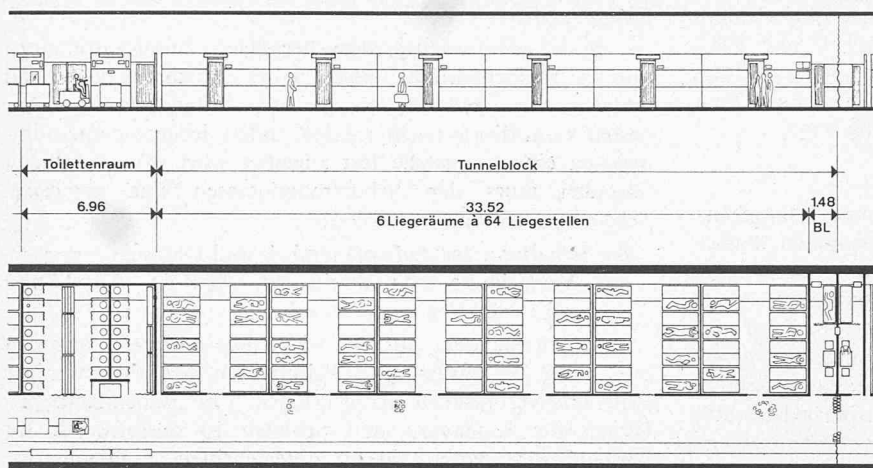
Tunnelblock (Grundriss und Schnitt).
